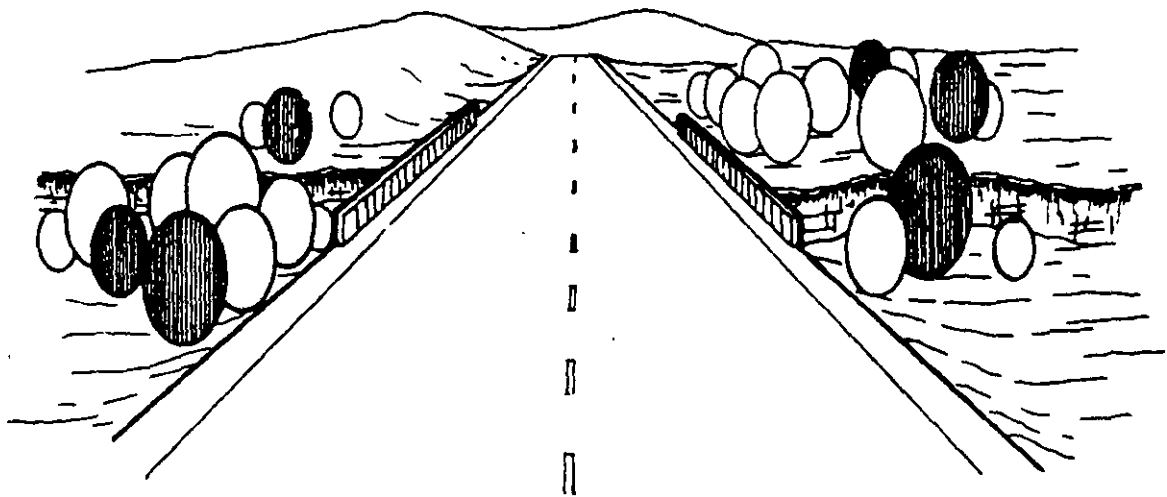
PLANTACIONES COMPLEMENTARIAS
